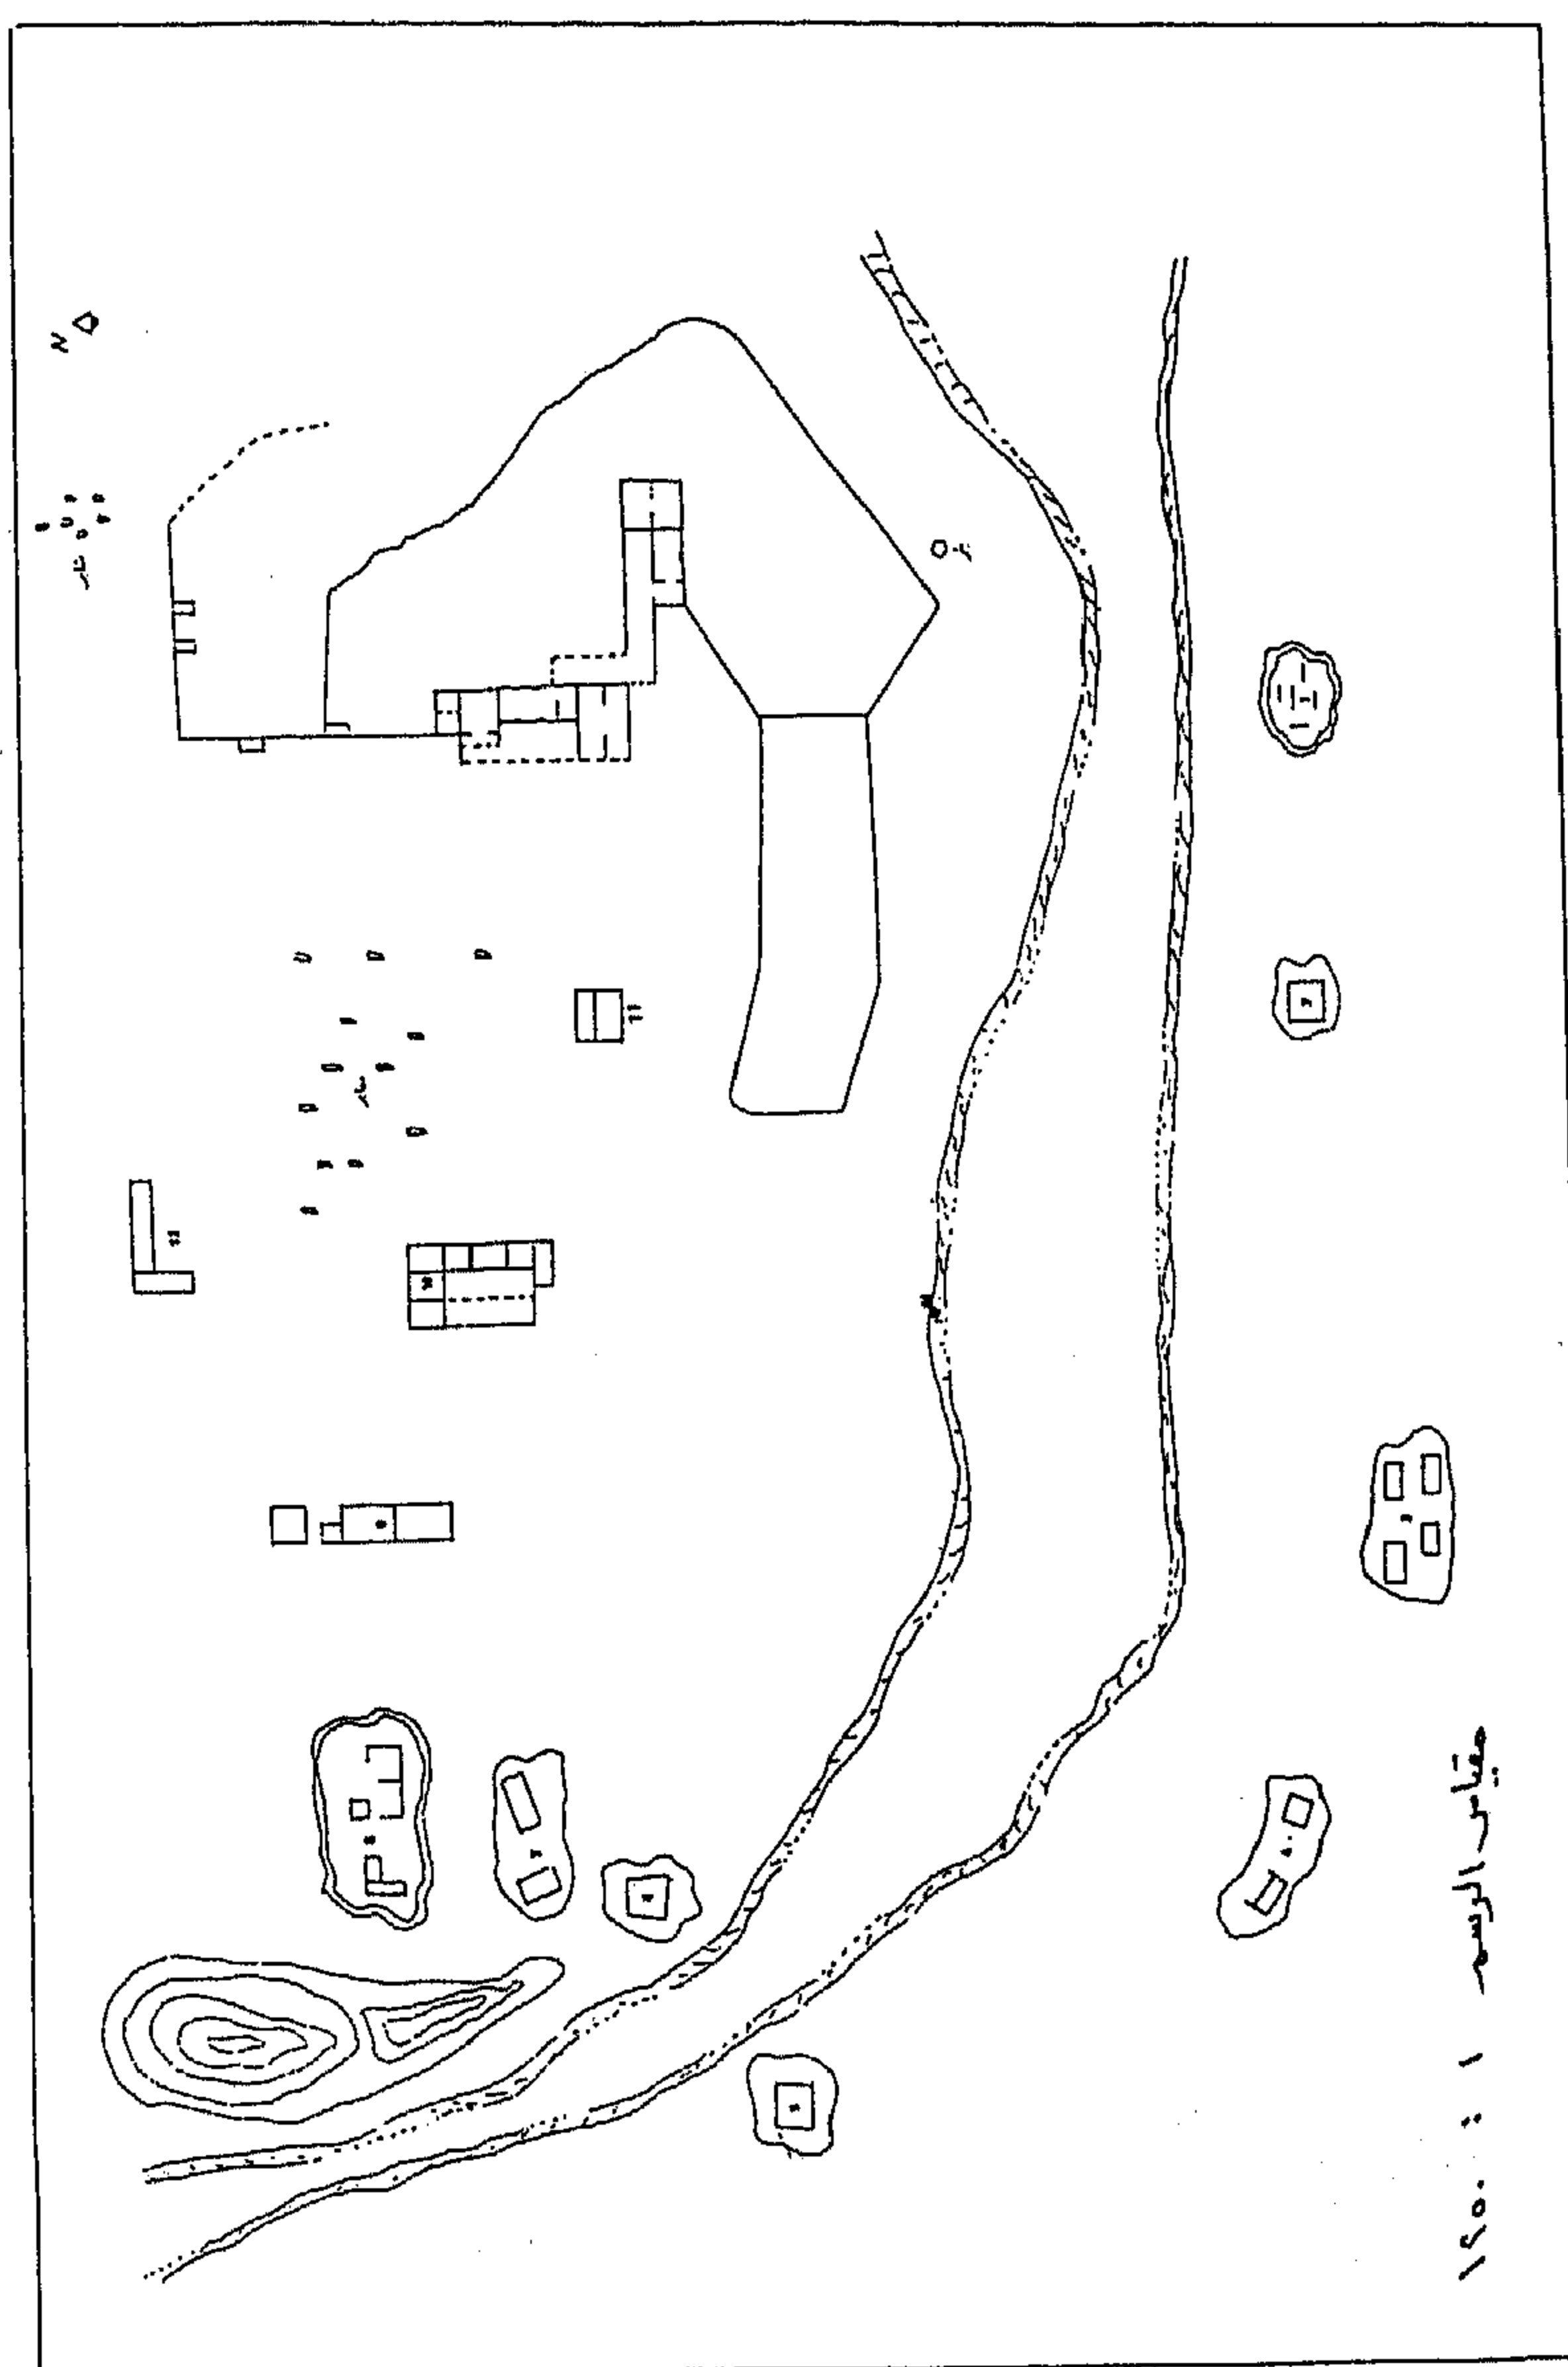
مسقط أفقي لسد وادي سيسد ، كما رسمته البعثة الأثرية المكونة من
